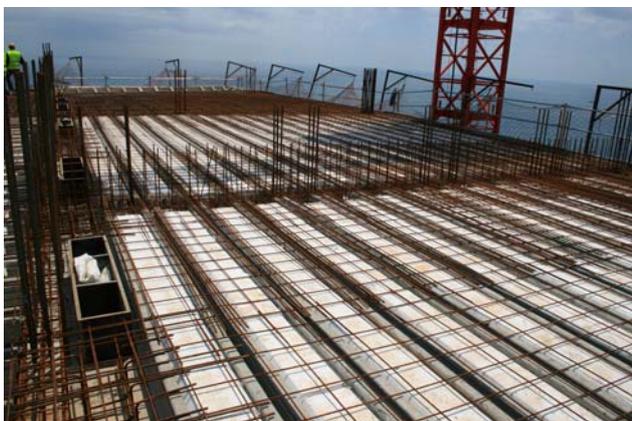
Vista de prelasas prefabricadas y ferralla superior de losa    Fig. 17: Vista de prelasas entre dos pantallas situadas a 9 m
